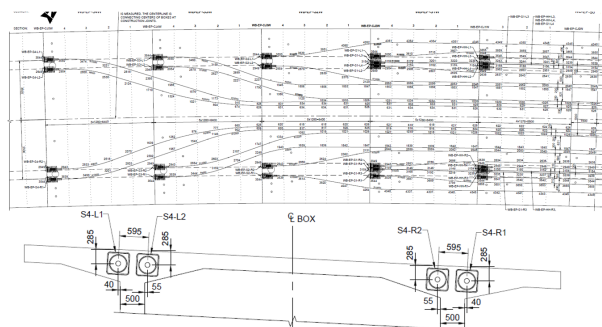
Trazado en planta en un voladizo con más tendones en la zona entre almas (superior) y frente de tesado estándar (inferior).
